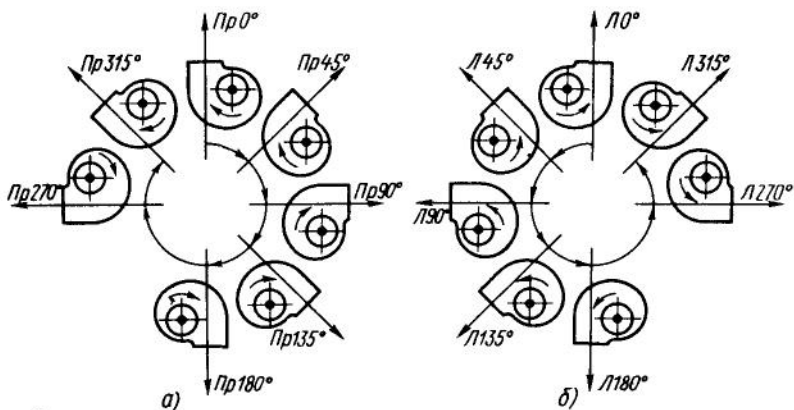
Схема расположения корпусов радиальных вентиляторов:
